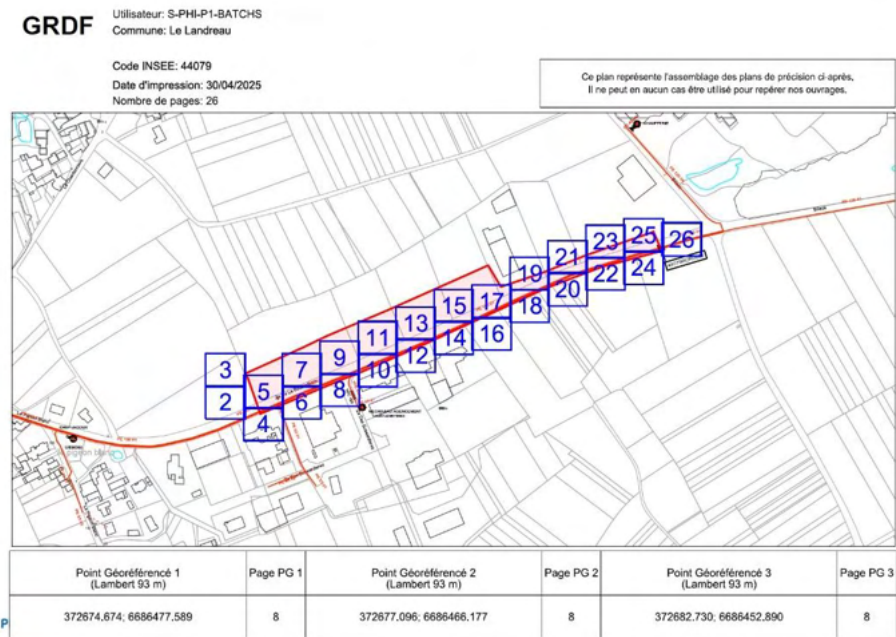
Plan de localisation des ouvrages gaz, réseaux et branchements sur l'amont du site d'étude (Source : GRDF – Direction réseaux Centre-Ouest)
